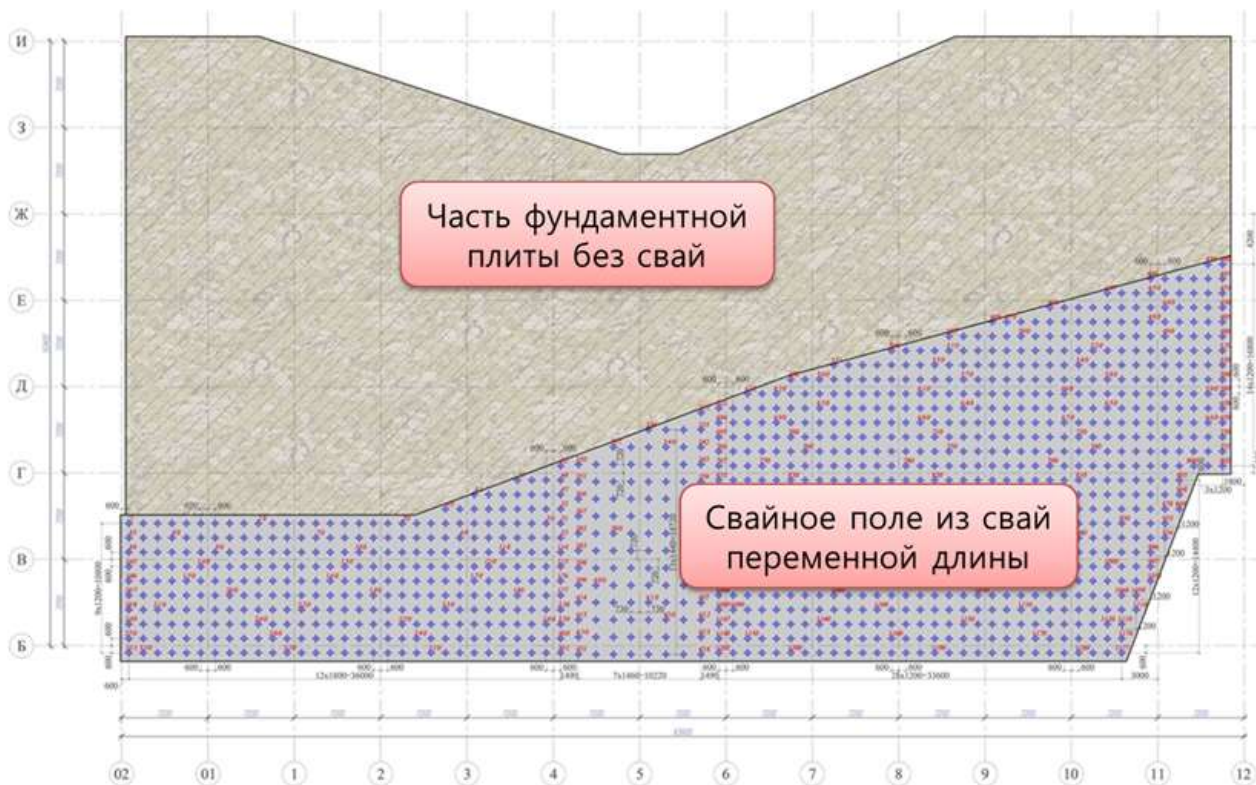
Схема расположения элементов вертикального армирования основания высотного жилого здания
